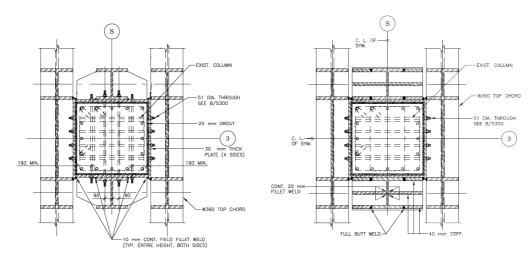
Detalle de conexión por soldadura (en cada esquina) entre placas de acero y verticales de los reticulados.
